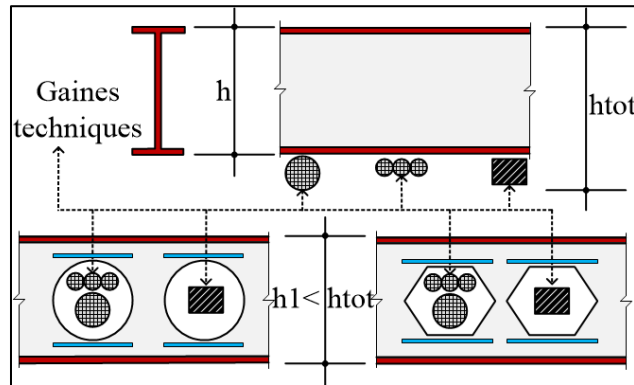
Utilisation des ouvertures dans les poutres ajourées
